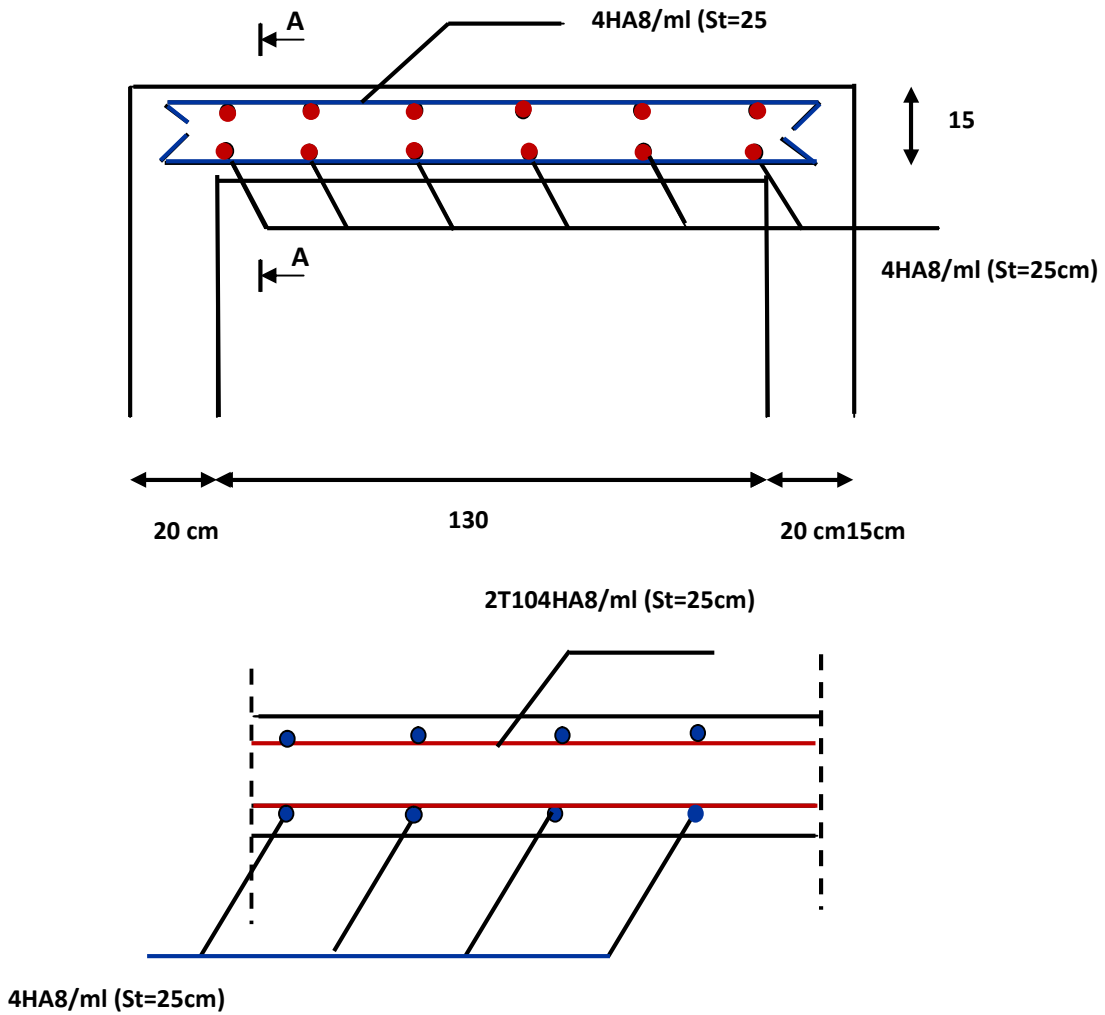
Ferrailage de la dalle du local Diagramme du
